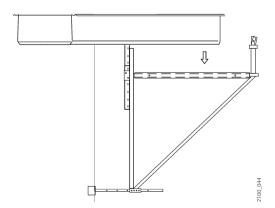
Montage des tôles de plancher sur la console de déport d'angle
